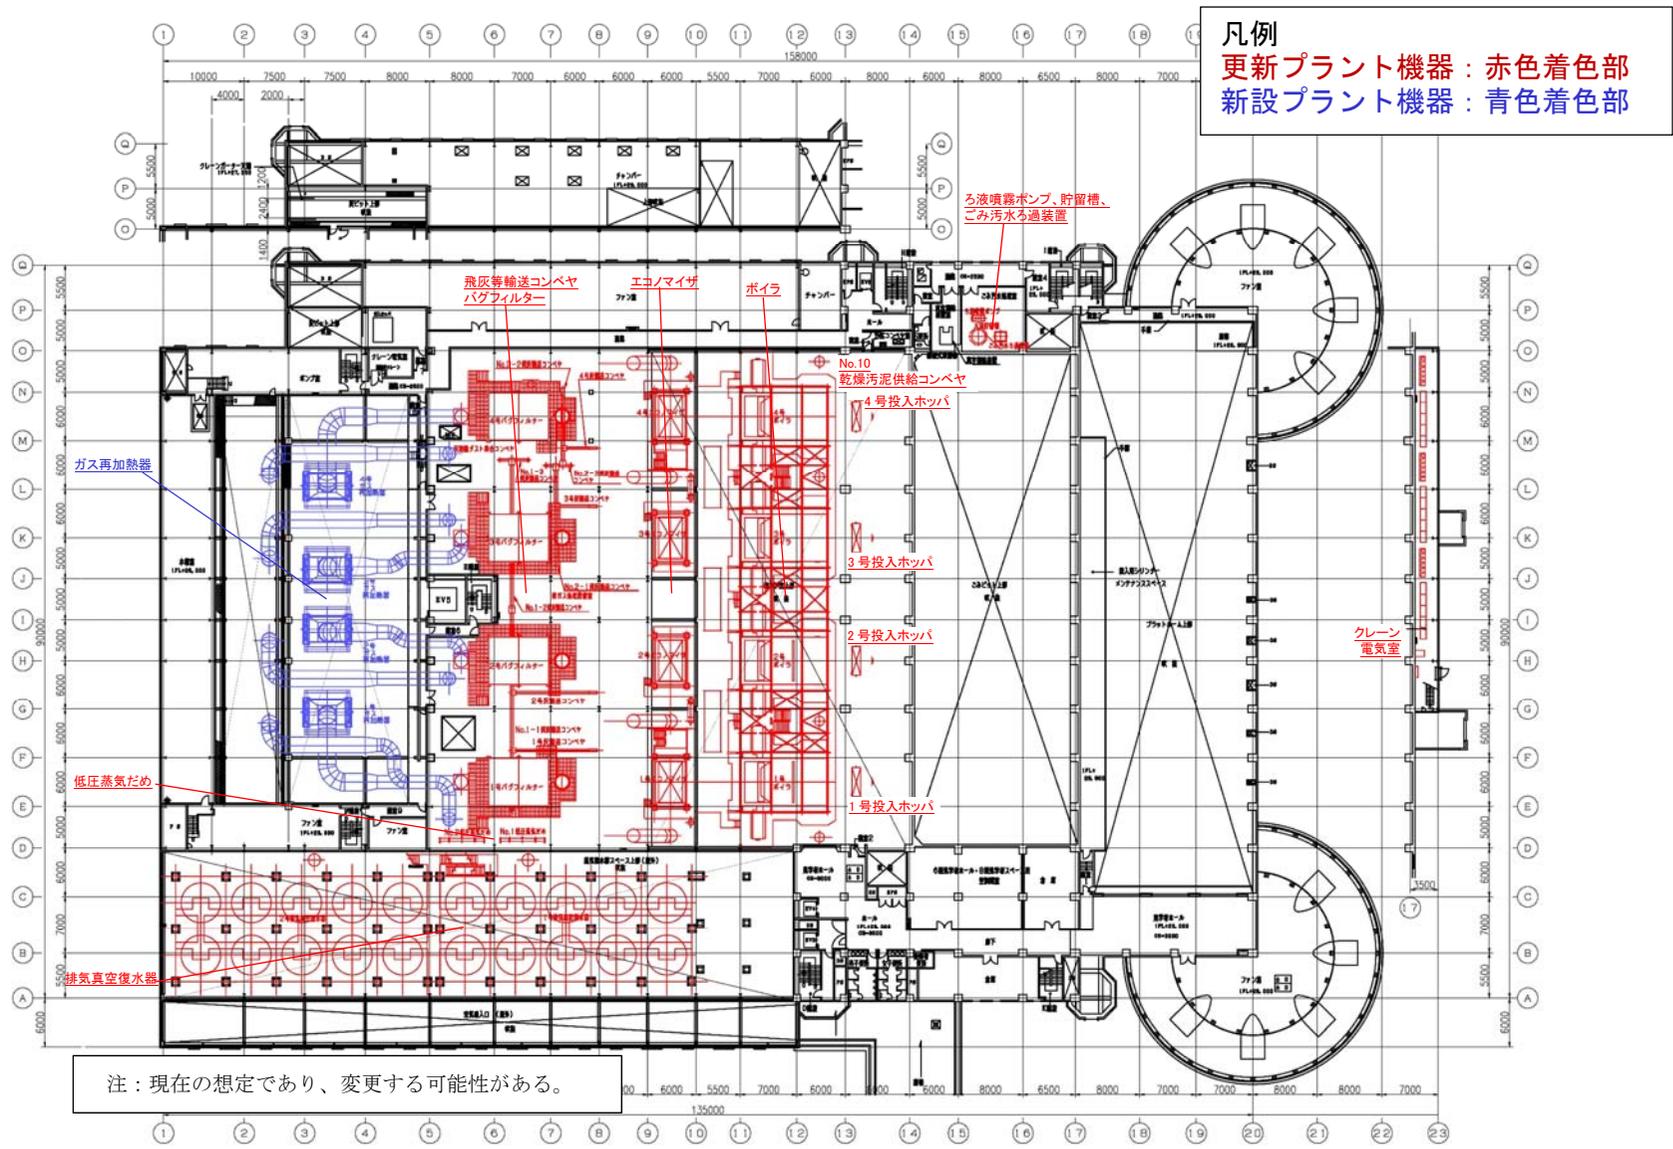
(6) 設備機器の更新箇所 (6・7階平面図)
